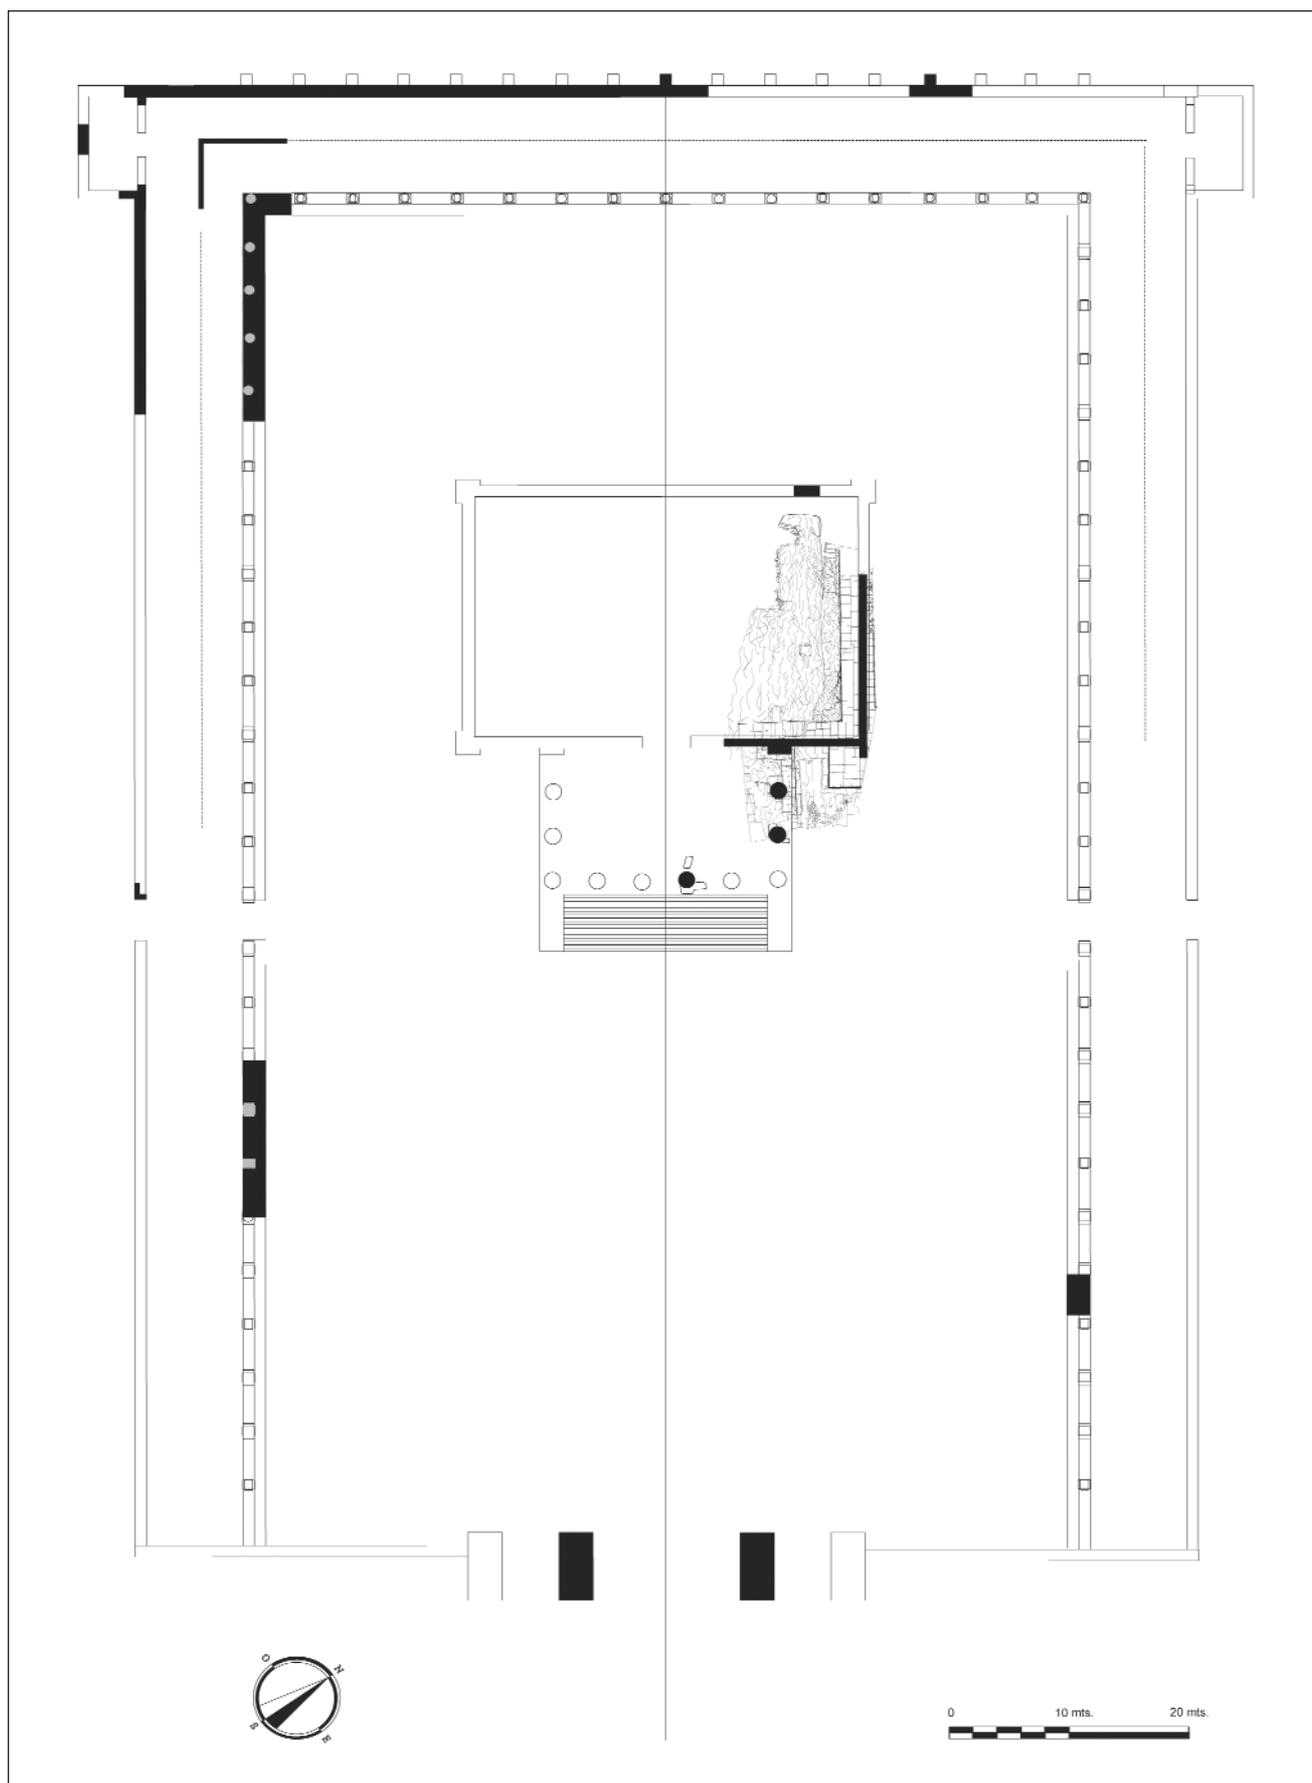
Reconstrucción hipotética de la planta esquematizada del conjunto monumental (según el autor).
